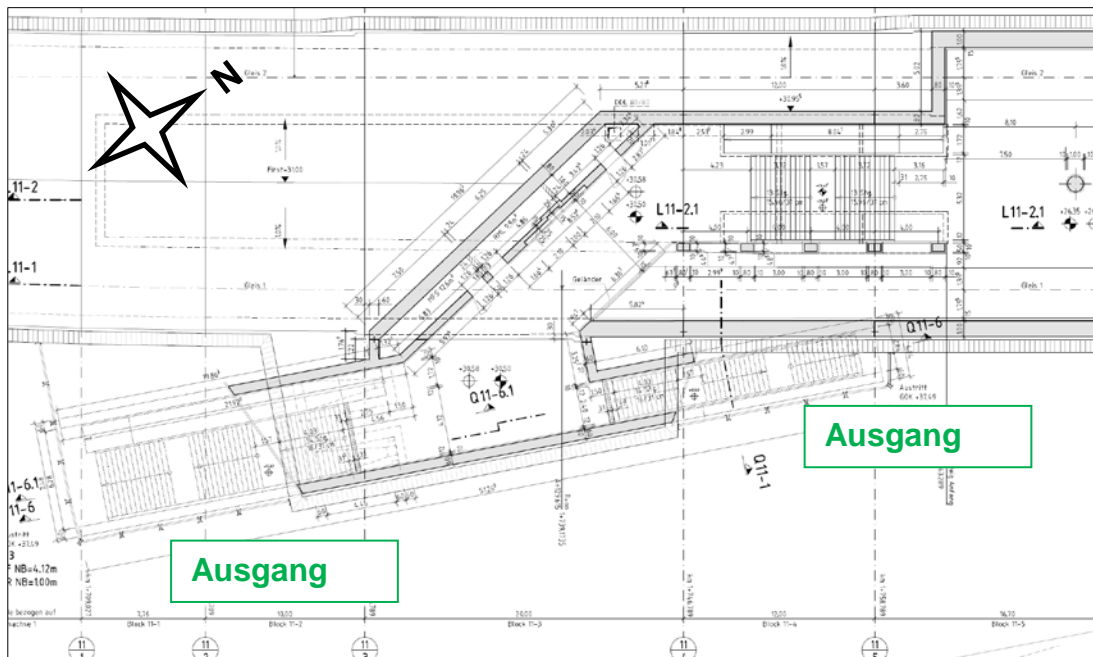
Grundriss Verteilerebene Süd - Auszug aus den Plangrundlagen (Quelle: IGV)
